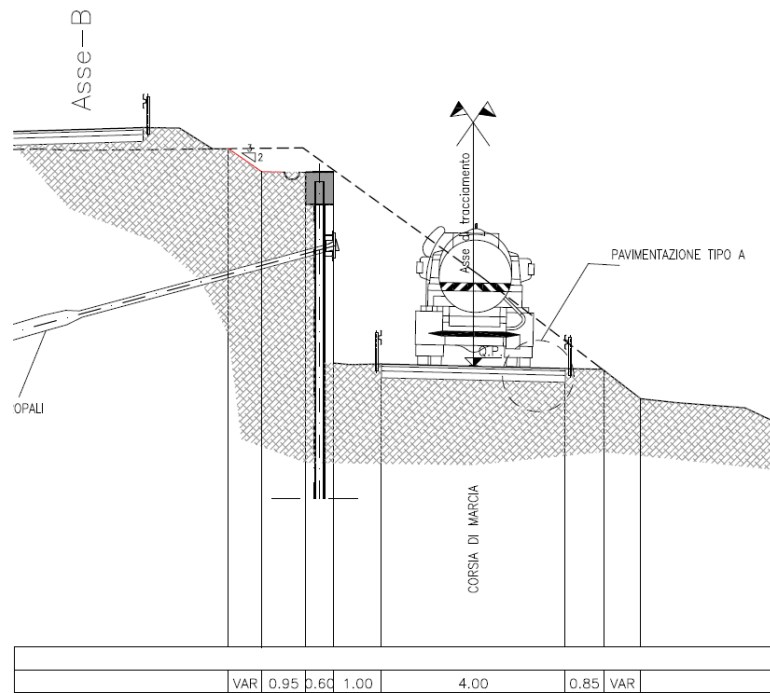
Sezione tipo strada di cantiere/security (paratia)
